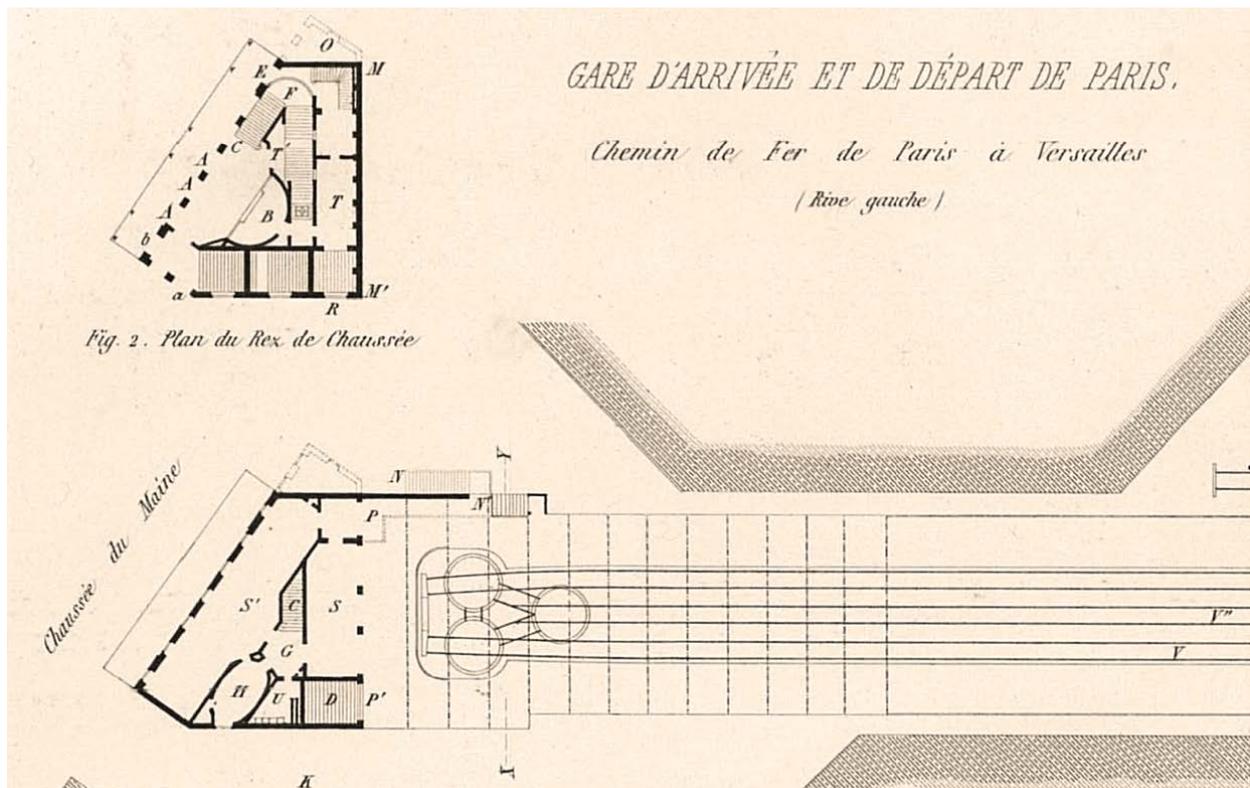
Plans du bâtiment voyageur 1840. Source : Revue générale de l'architecture 1840
